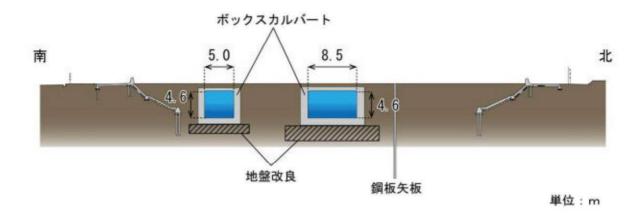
工作物(ボックスカルバート)の標準断面図
